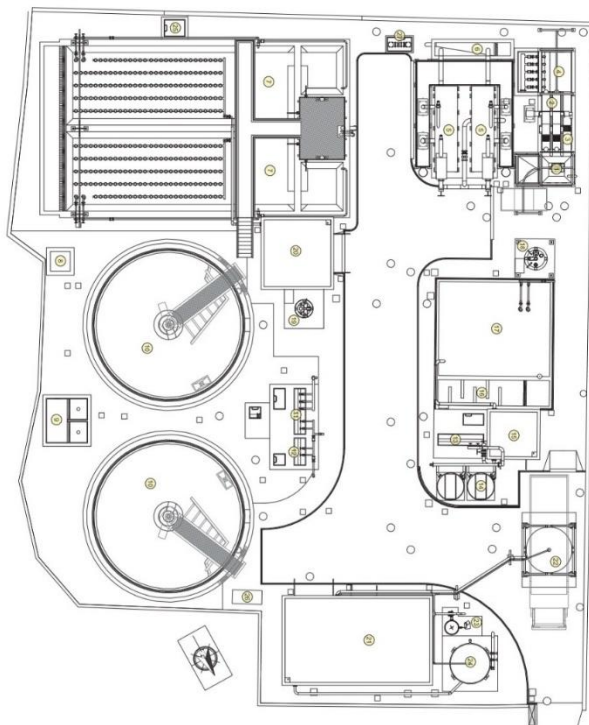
PLANO IMPLANTACION GENERAL
